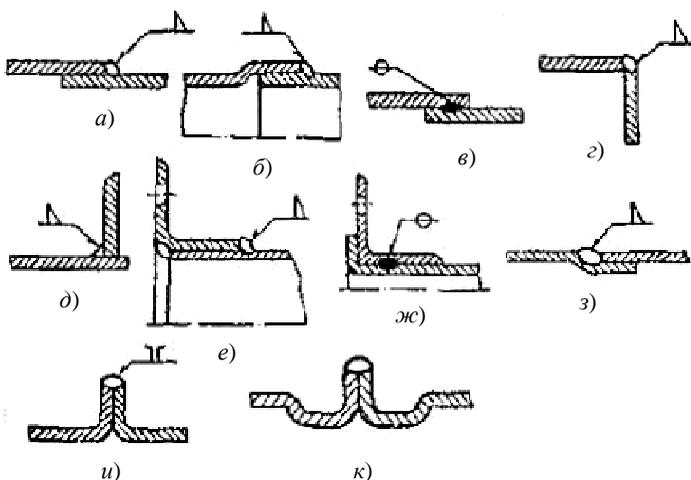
Виды сварных соединений металлических воздуховодов:
